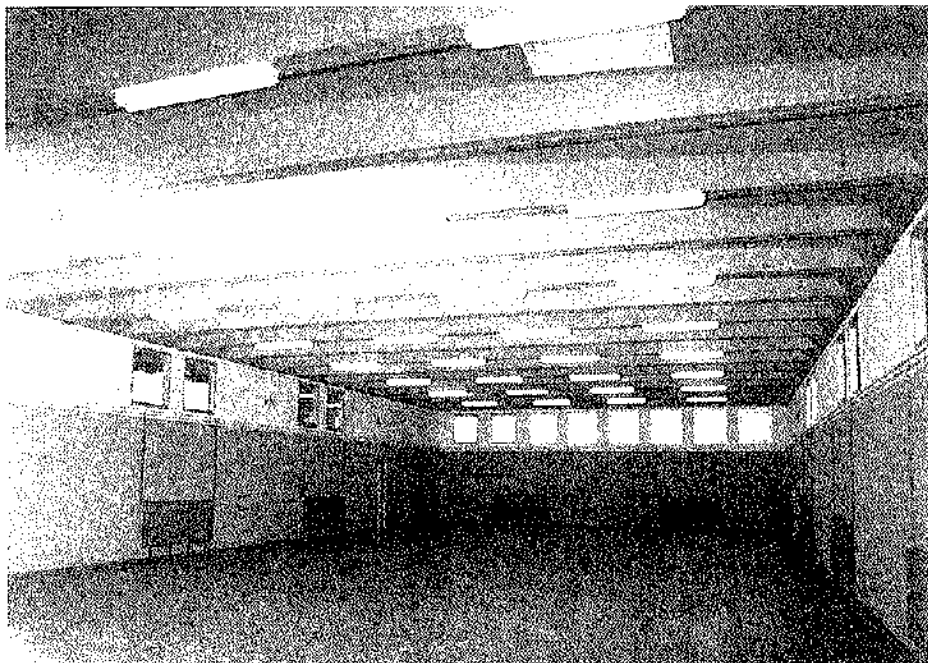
Edificio prefabricado, con paneles de cerramiento estructurales.
